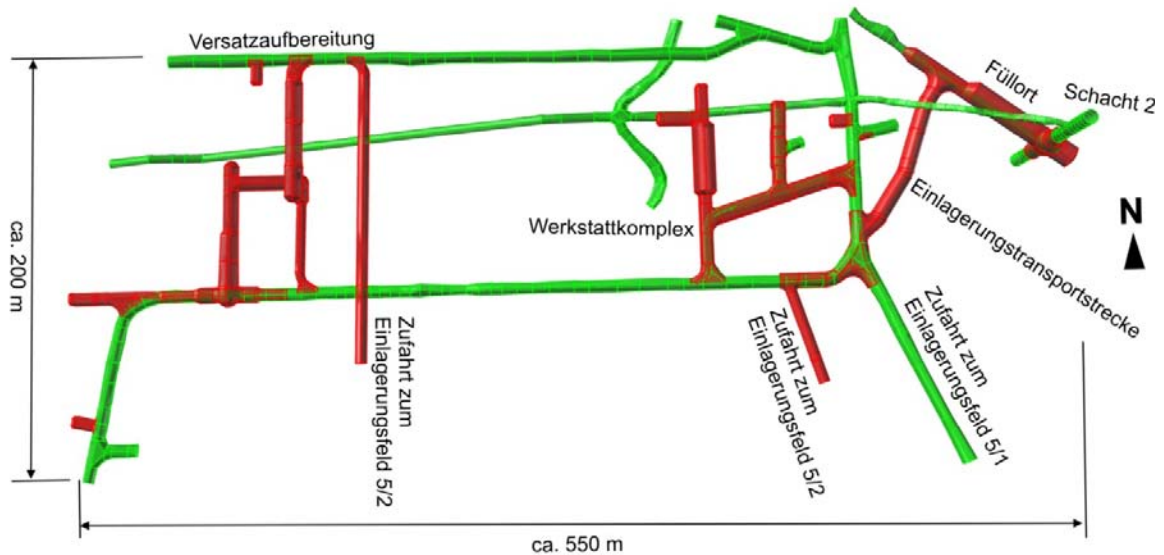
Grundriss der 850 m-Sohle (Ausschnitt) mit bestehenden Grubenbaue (grün) und Baumaßnahmen (rot)
